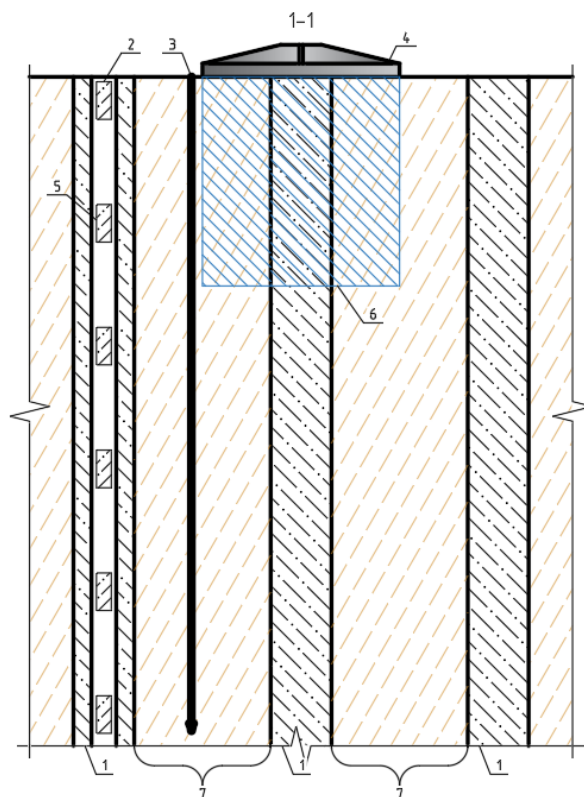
Фрагмент схемы расположения вертикальных грунтоцементных элементов: 1 – вертикальные армирующие элементы; 2 – скважина от сквозного бурения; 3 – точка статического зондирования грунтов; 4 – штамп
